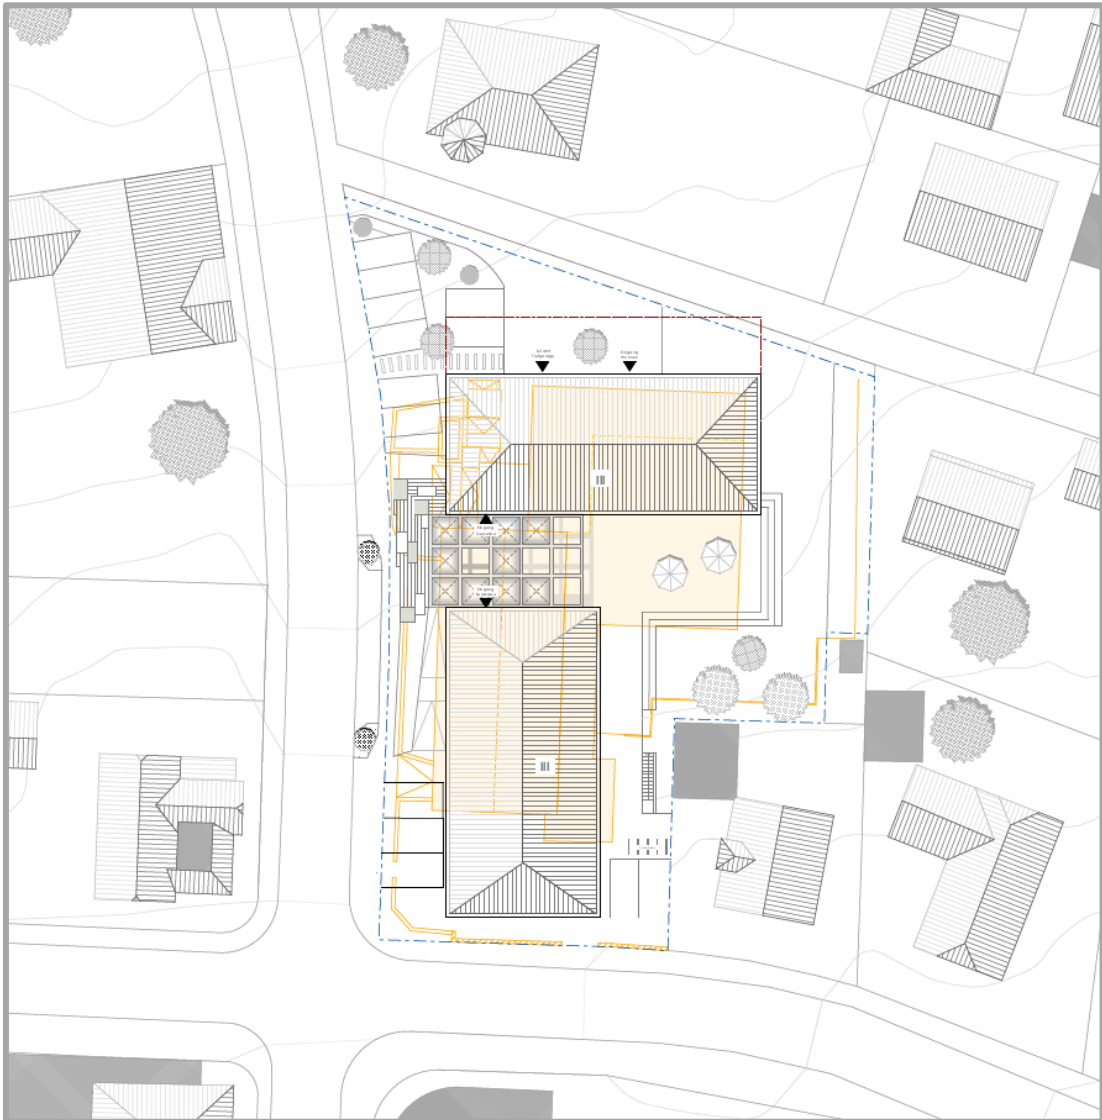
Lageplan Vorhaben, unmaßstäblich (Quelle: Kuhn Architekten Stadtplaner)
